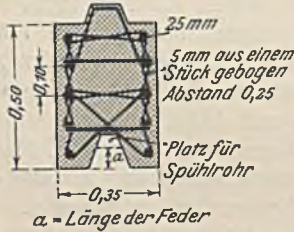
Eisenbetonspundbohle mit keilförmiger Nut und Feder.
